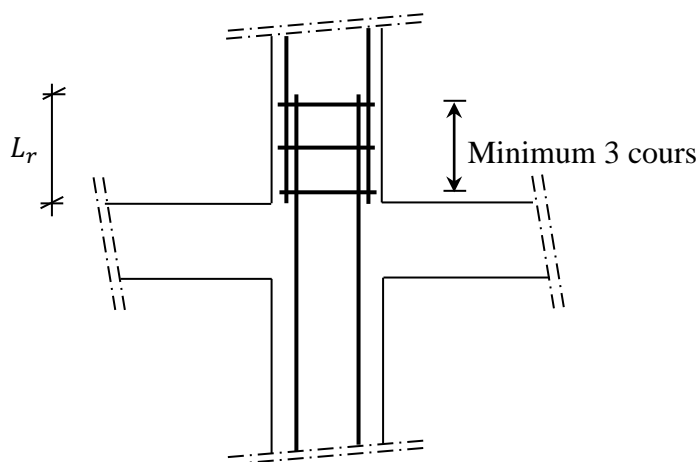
Les armatures transversales dans la zone de recouvrement
